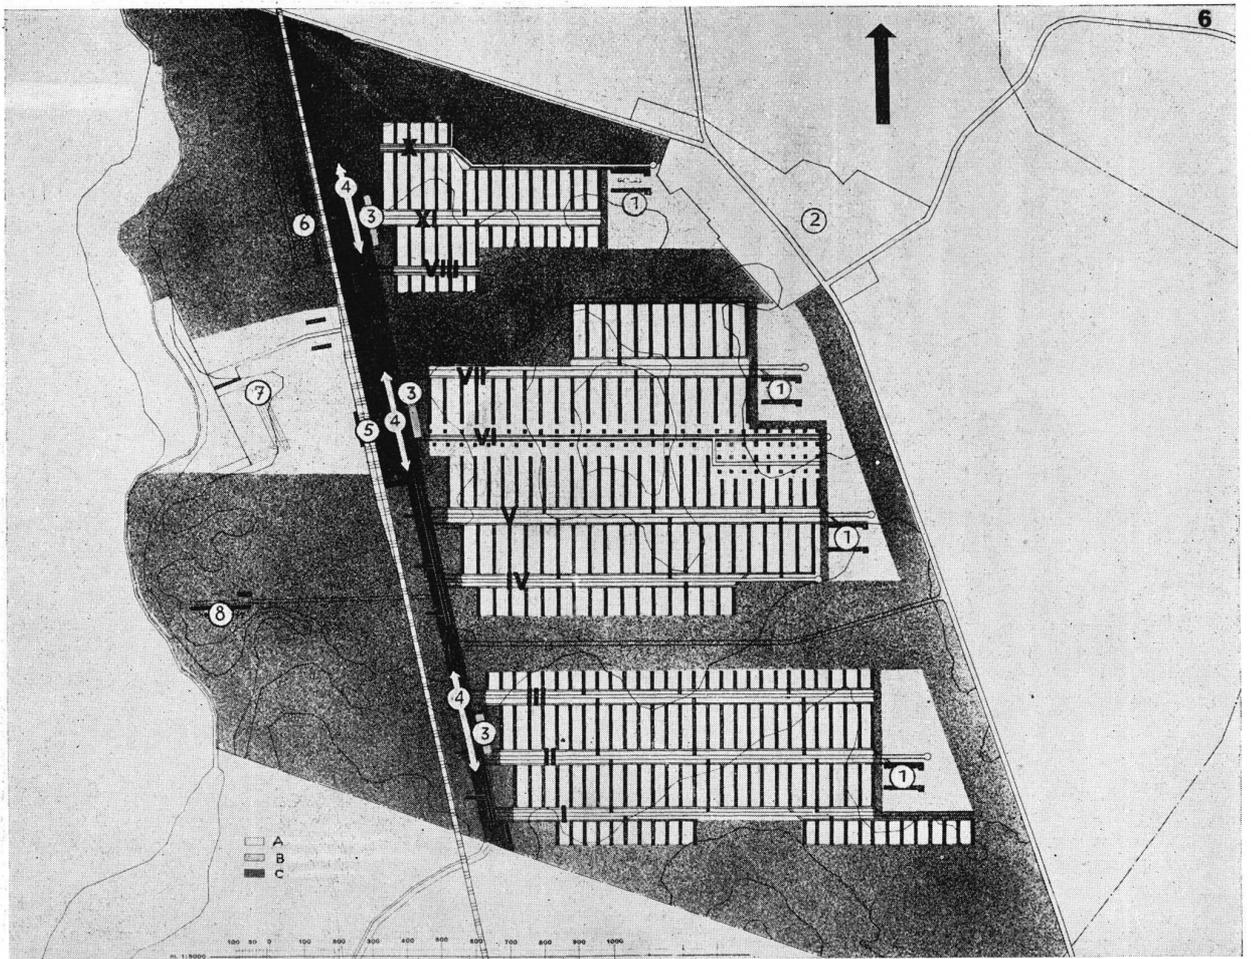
PLANO DE APROVECHAMIENTO DEL TERRENO I
